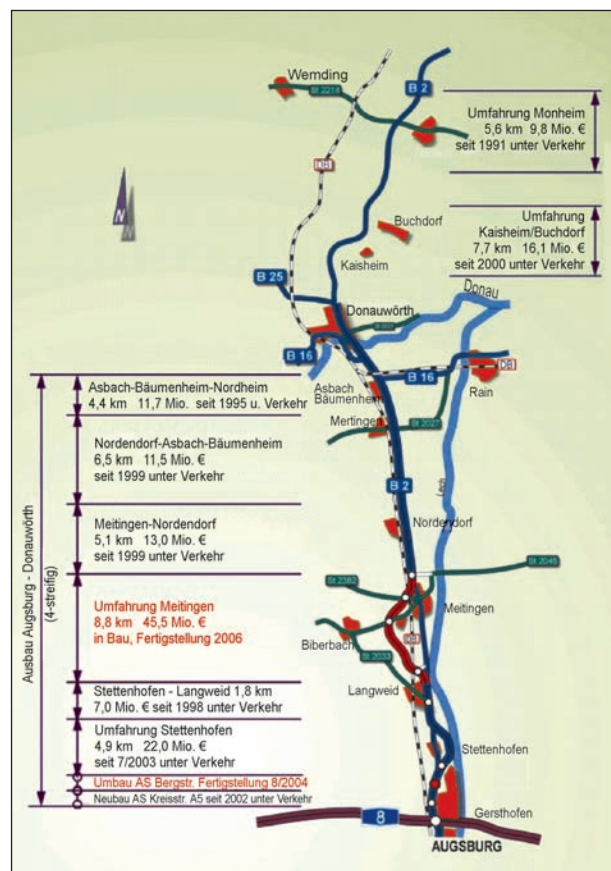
Übersichtslageplan B 2 Augsburg-Donauwörth
